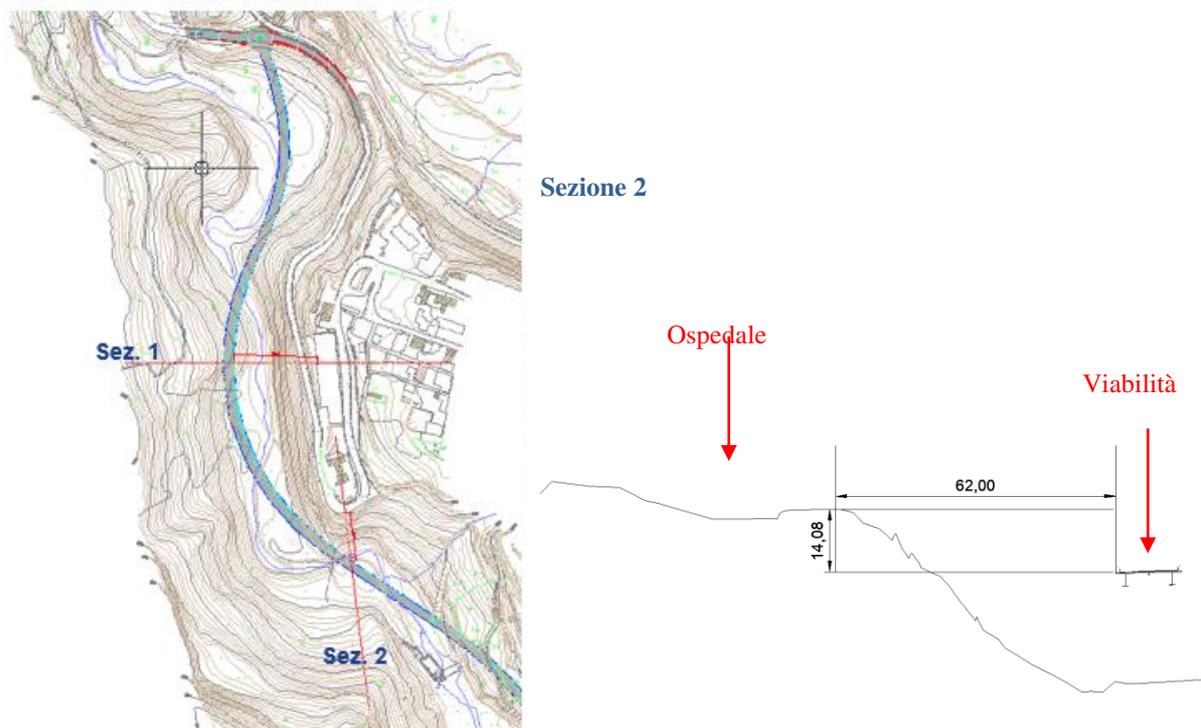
Traccia sezioni e sezione 2: Ospedale – viabilità in progetto
